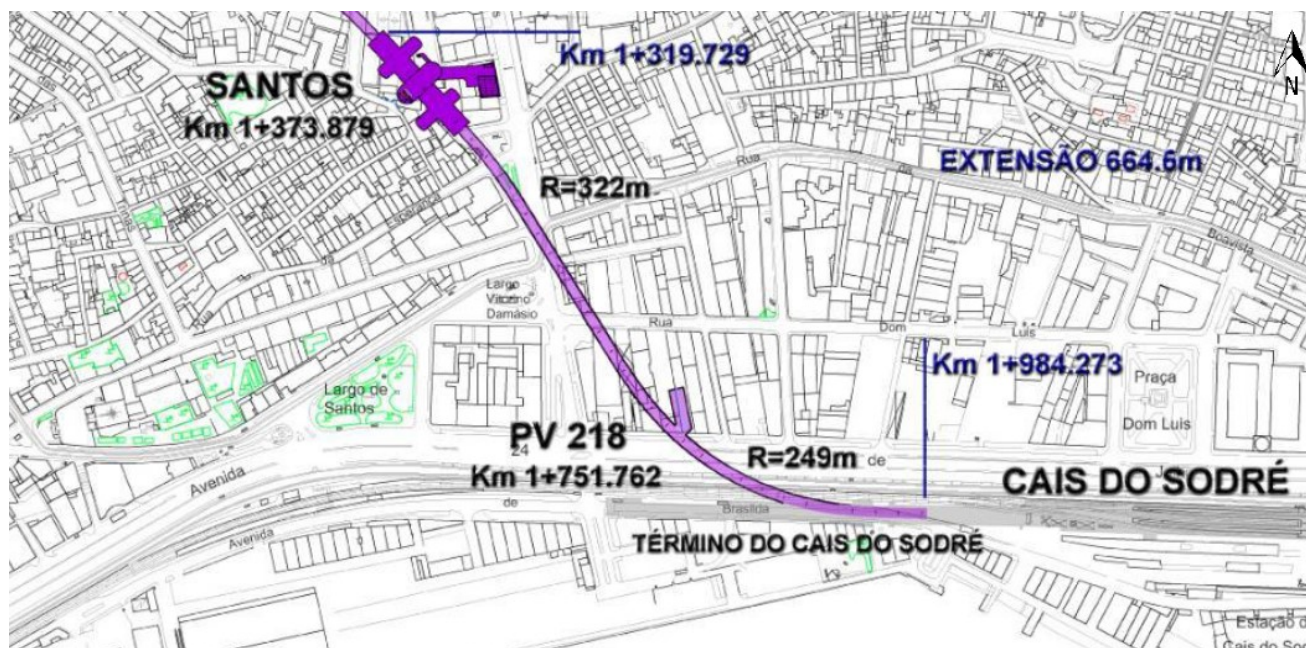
Traçado em planta do Lote 2 (Fonte: RECAPE)
